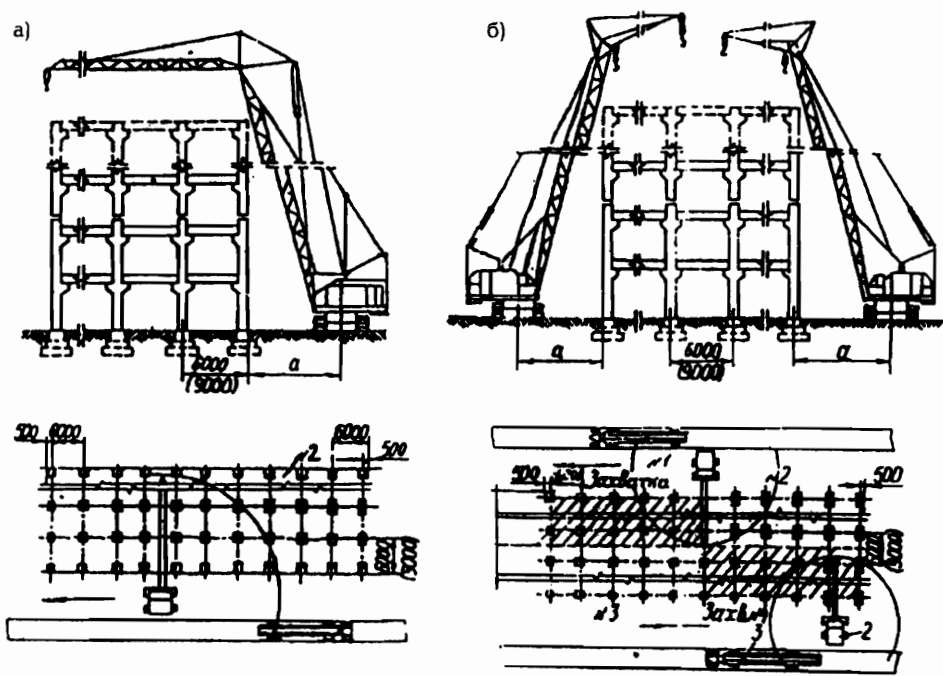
Технологические схемы монтажа каркасов зданий с использованием: а - одного башенно-стрелового крана; б - двух стреловых кранов
